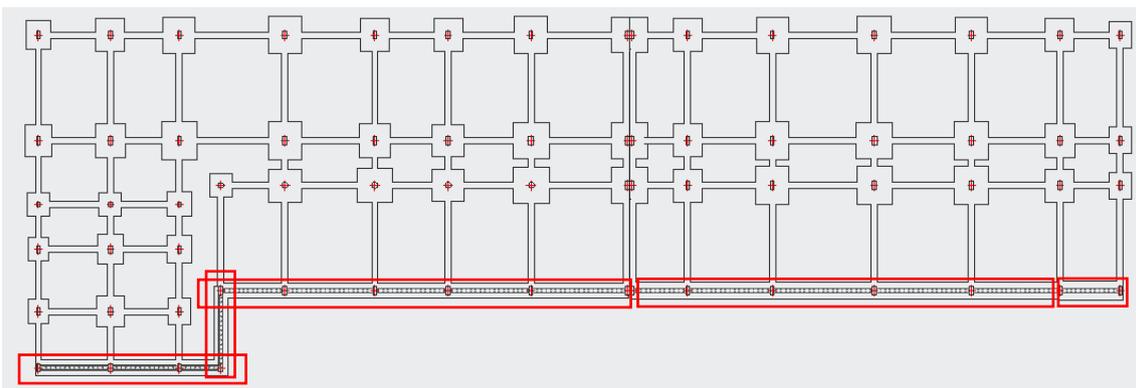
Plano cimentación Sótano. Ubicación muros.
